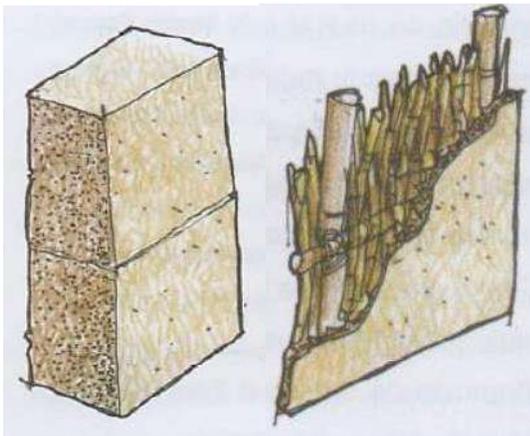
Detalle de Muro en tapia y Muro en Quincha Fuente: Arquitectura Vernácula peruana Jorge Burga pag. 26
